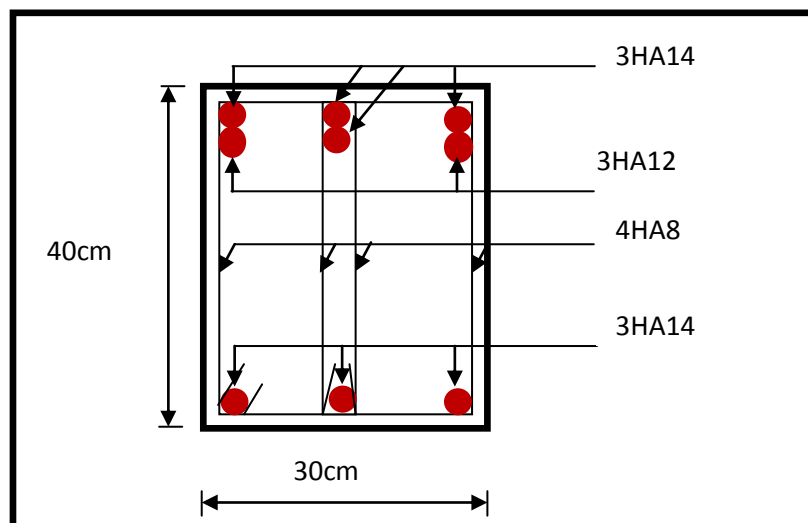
Ferrailage sur appuis d'une poutre principale.
